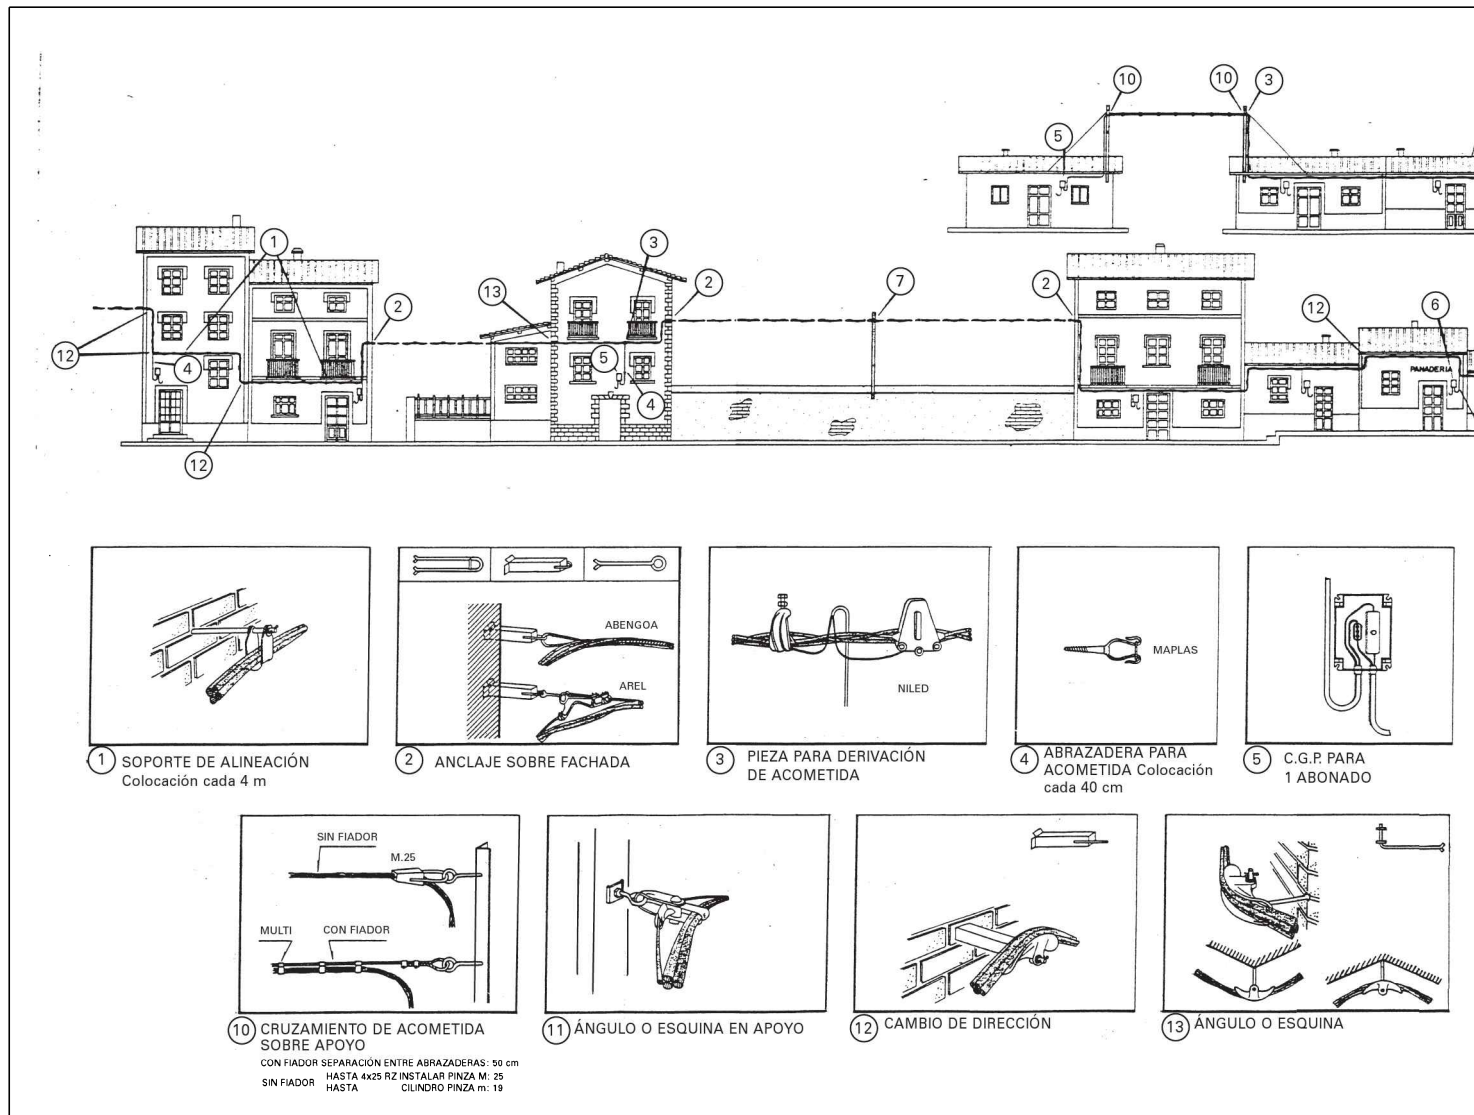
Redes aéreas tensadas sobre fachada para Baja Tensión.
